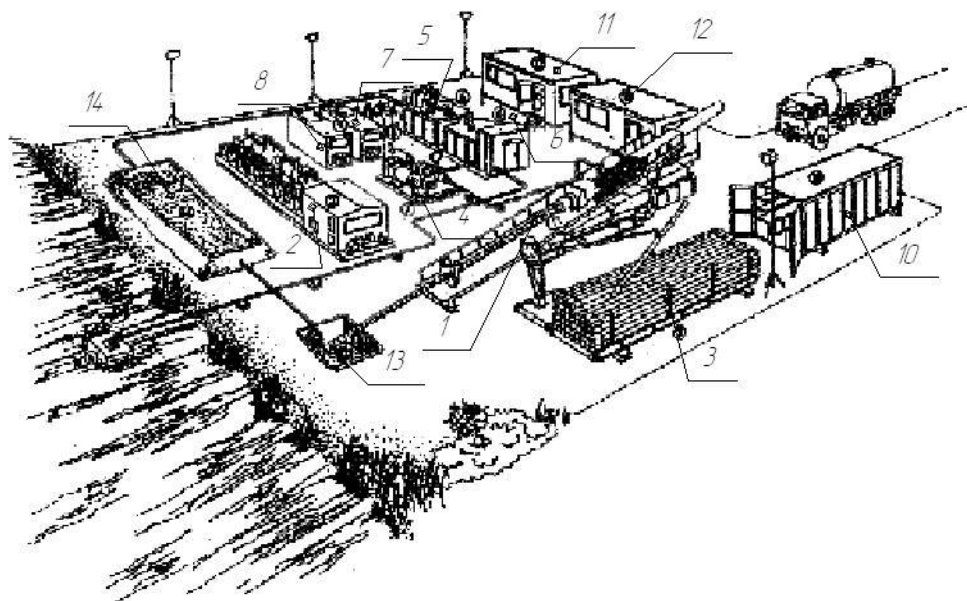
Схема размещения установки ГНБ на строительной площадке
